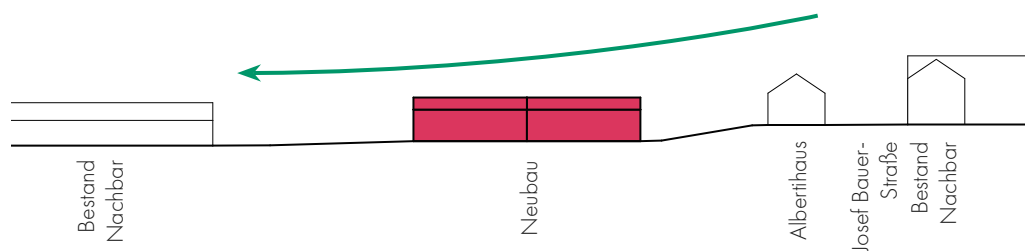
Schemaschnitt durch das Planungsgebiet: Gebäudehöhenanpassung
